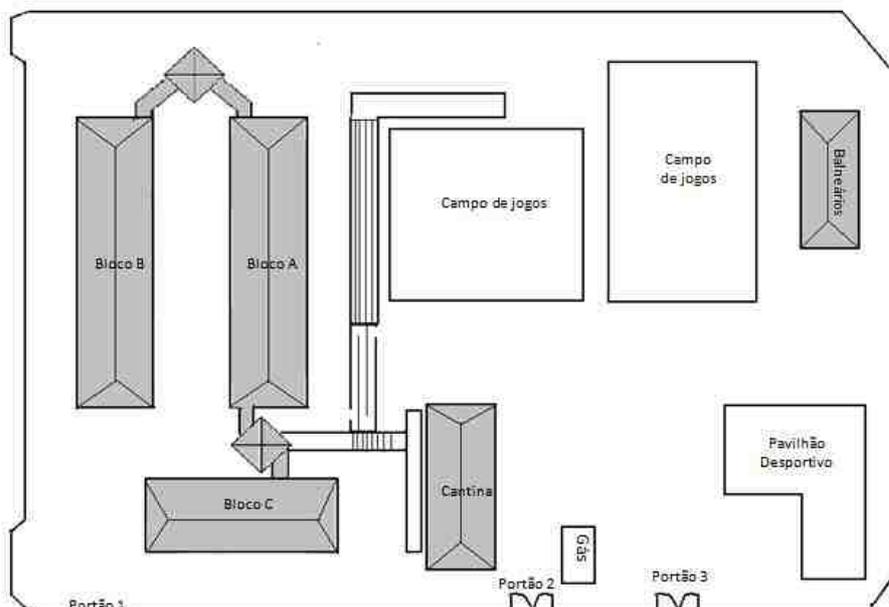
Planta da Escola EB 2/3 Cidade de Castelo Branco
